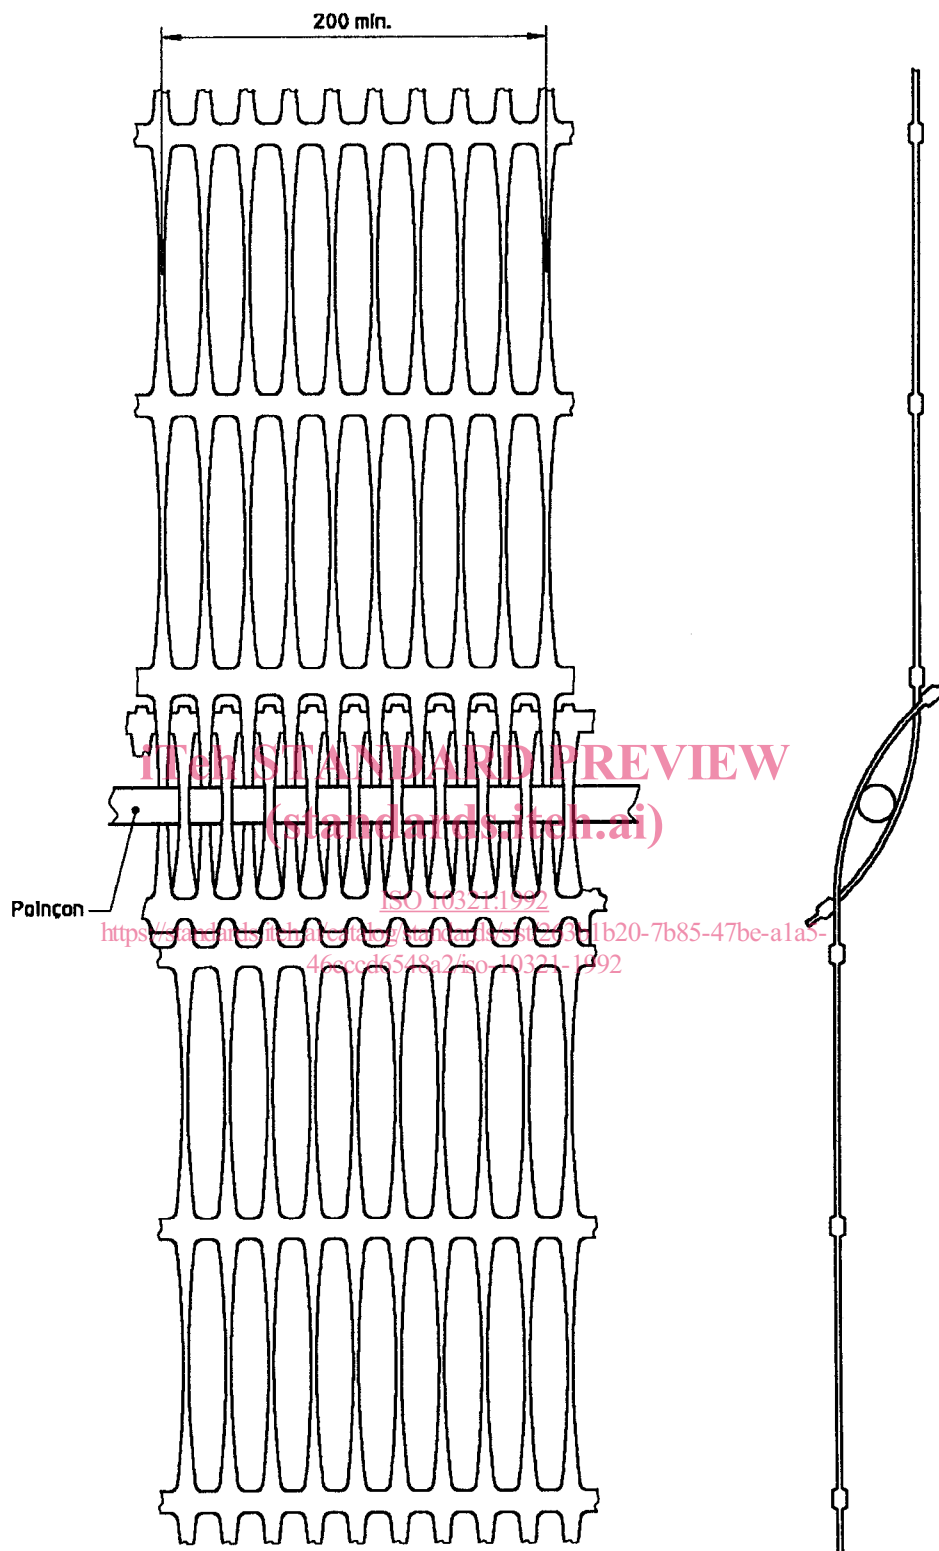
Exemple d'éprouvette à joint/couture de géogridde
